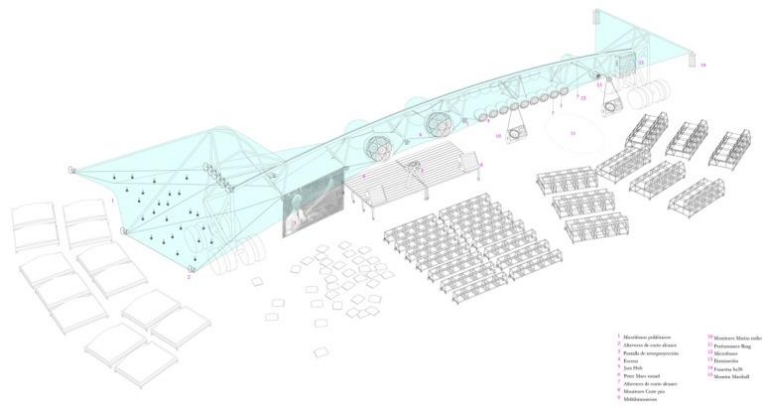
Desenho esquemático da estrutura Escaravoux
